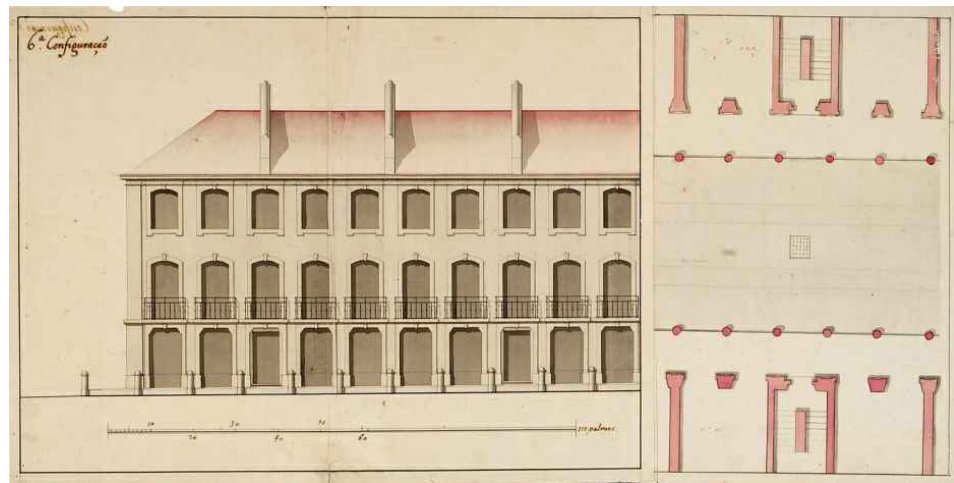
Fachada - 6ª Configuración, con el plano de una calle que se supone ser parte del dibujo de la 5ª Configuración (MC. DES. 1079).
